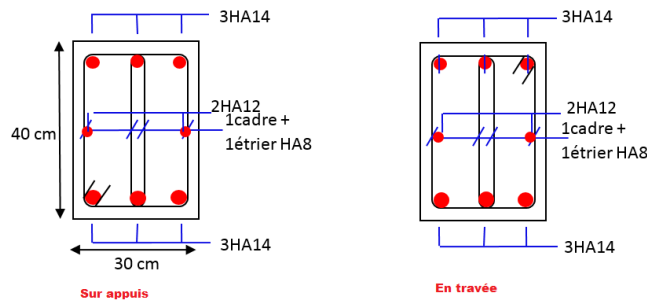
Ferraillage des poutres principales (30 × 40)
